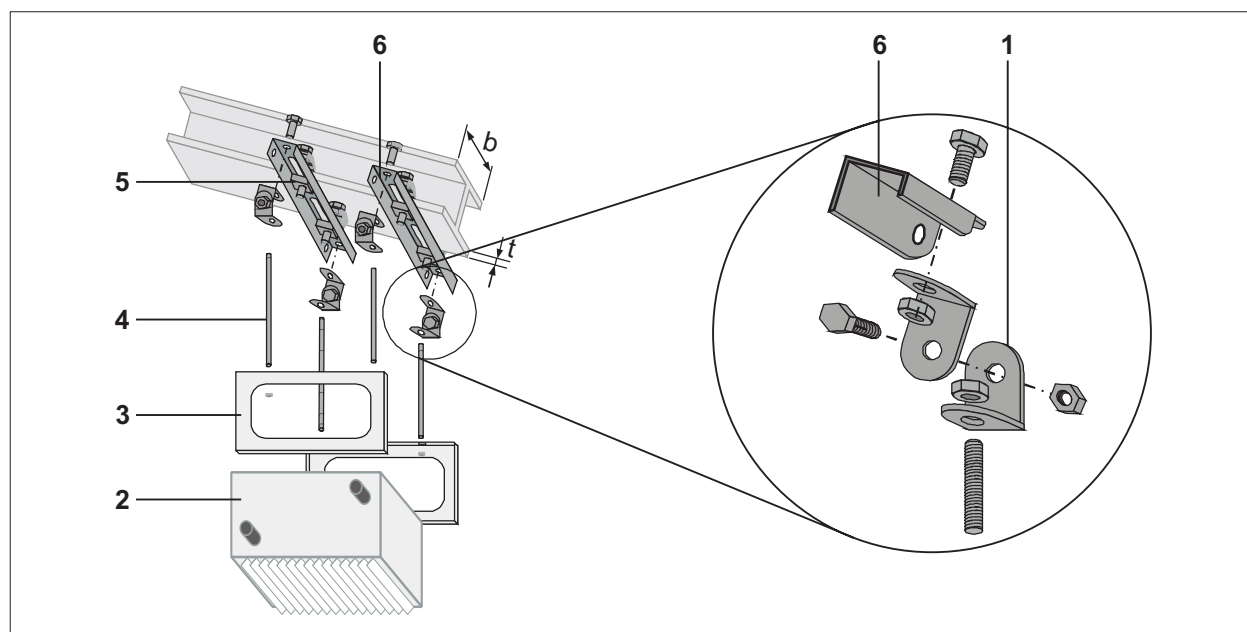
Монтаж набора для крепления к горизонтальной и к наклонной стальной балке с выравниванием наклона
